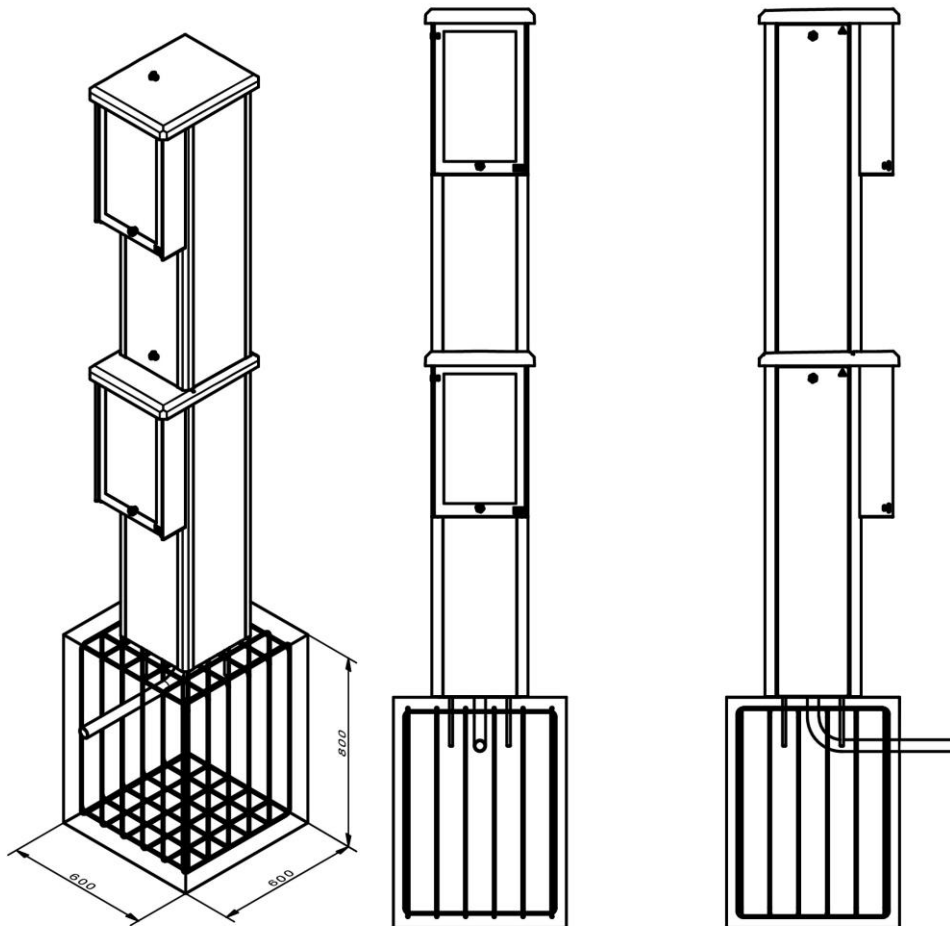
Standgehäuse PKW / LKW mit Fundament inkl. Bewehrung und Leerrohr
